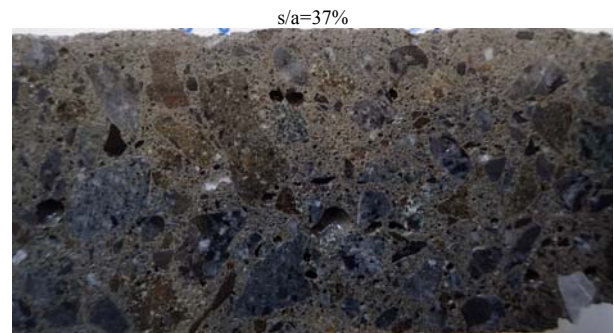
内部振動機挿入位置 75mm，鉄筋あき 40mm
